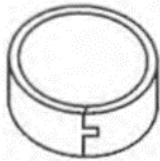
Tipos de ligações estruturais de peças de madeira.
